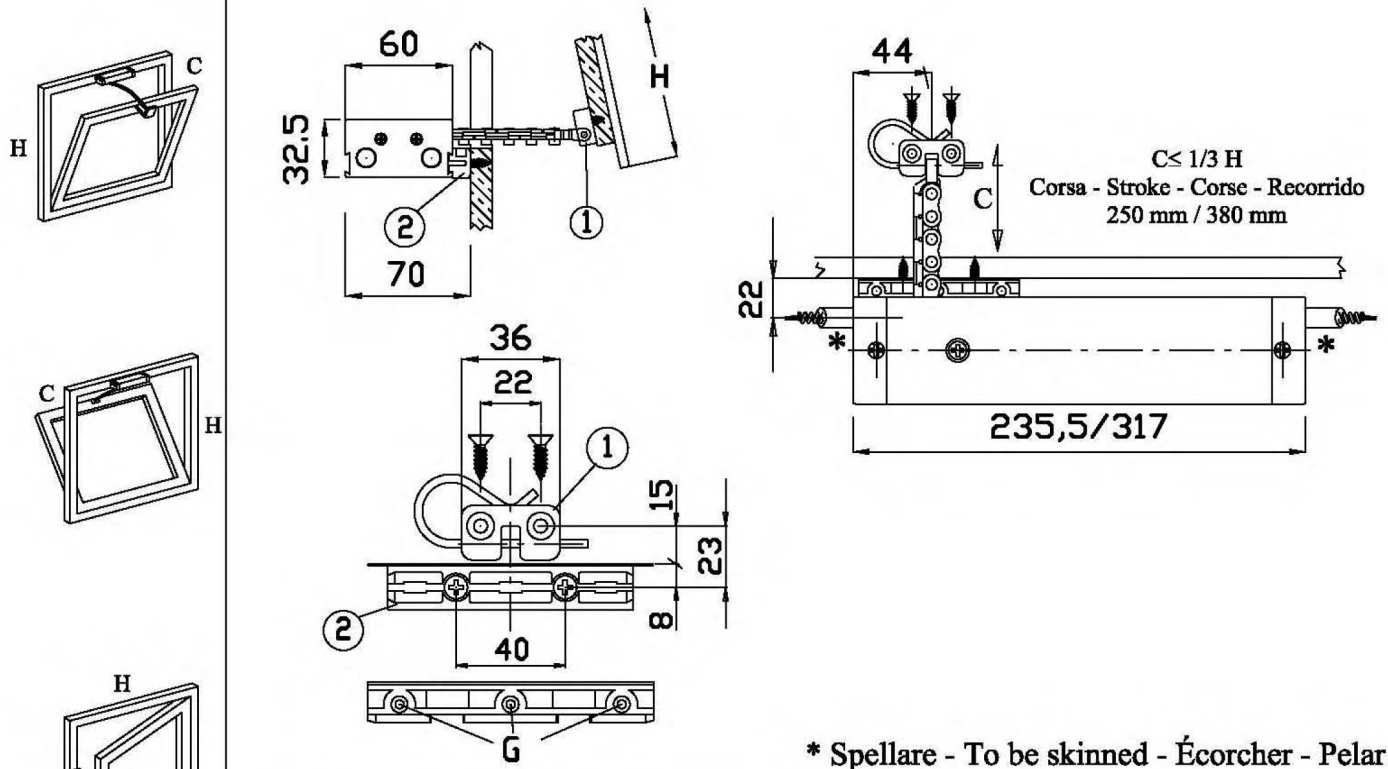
Installazione su finestre a vasistas – Installation on top bottom windows –
